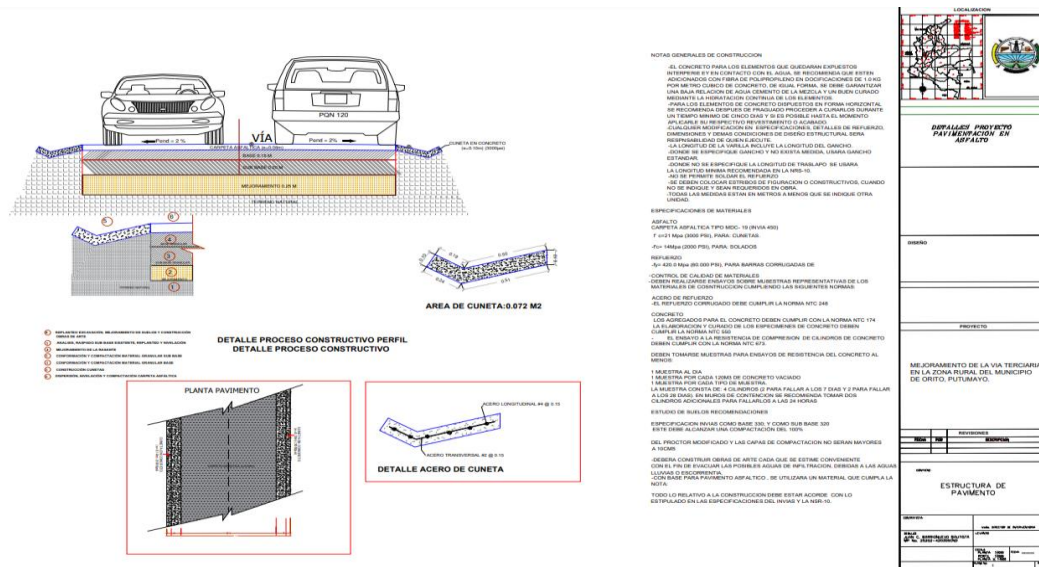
Detalles de la estructura del pavimento. Fuente: Secontsa
